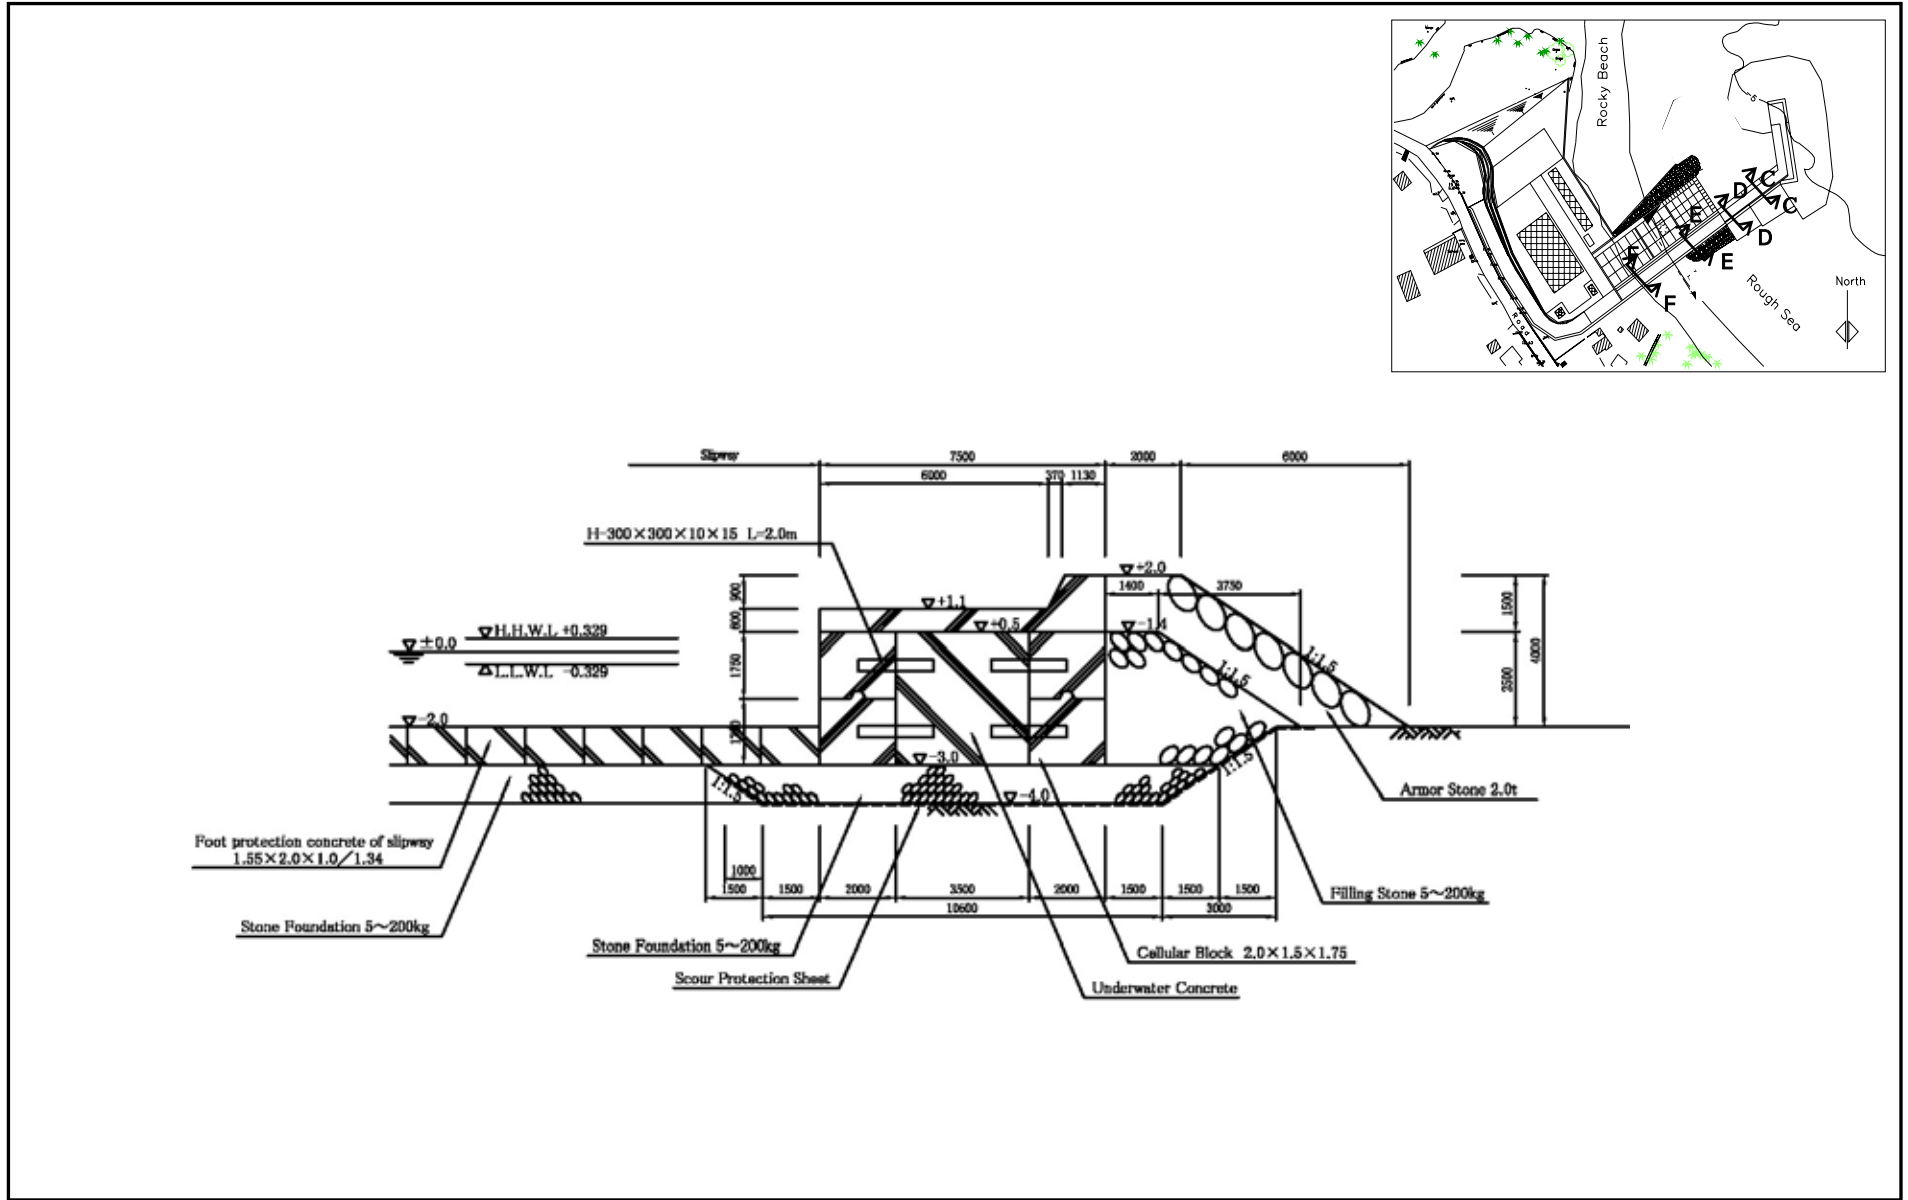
(6) 防波護岸断面图 (E-E 断面)
